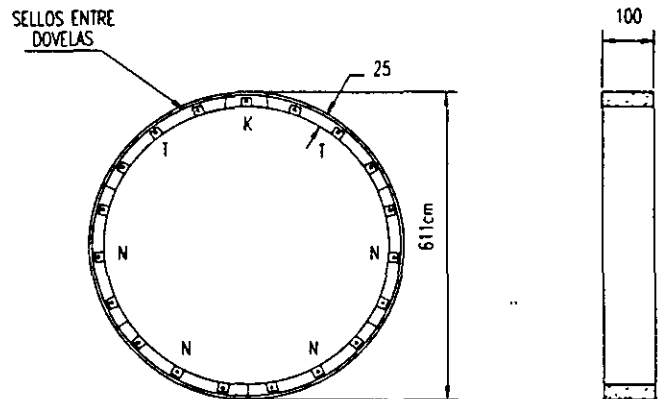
ANILLO DE DOVELAS DE CONCRETO REFORZADO
